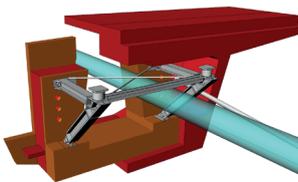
Chargement d'un ensemble poutre-poteau ; 1b. Schéma optimal de bielles en béton (en bleu) et renforts d'aciers orthogonaux (en rouge) © Leyla Mourad, 2021.
